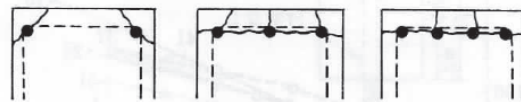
割れ裂きひび割れパターン^{4.2)}
